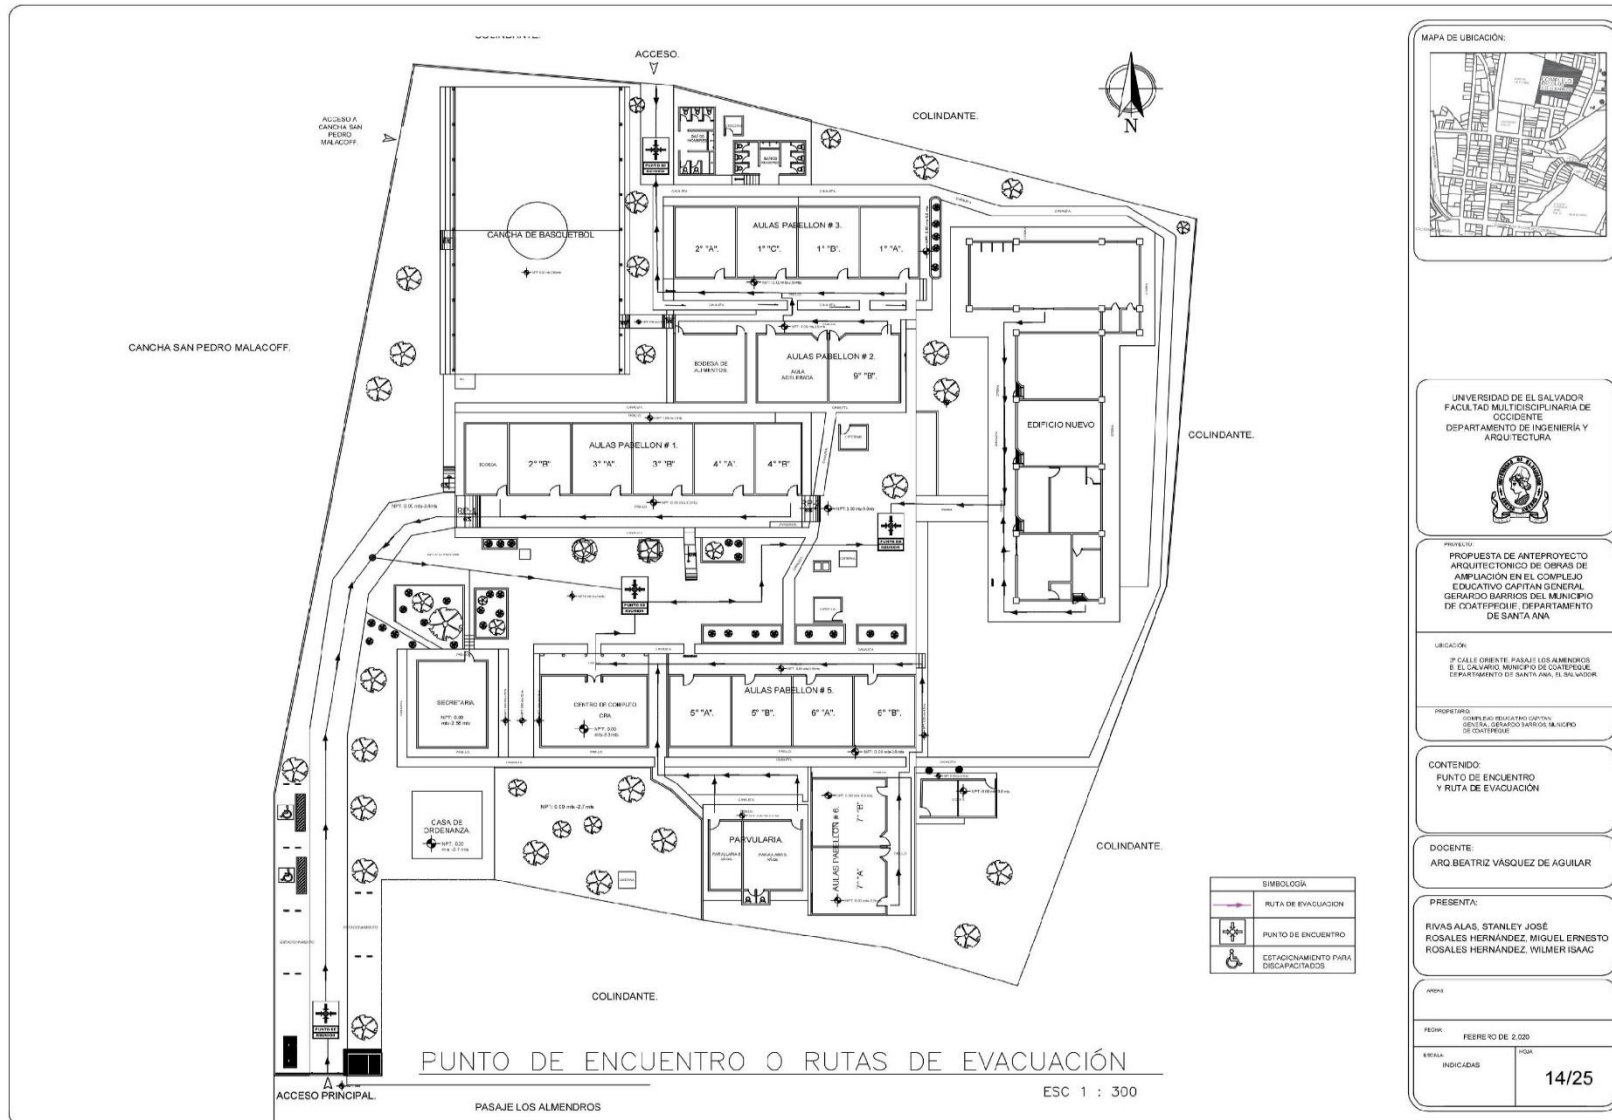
PLANTA DE RUTA DE EVACUACIÓN "PROPUESTA DE ANTEPROYECTO".
